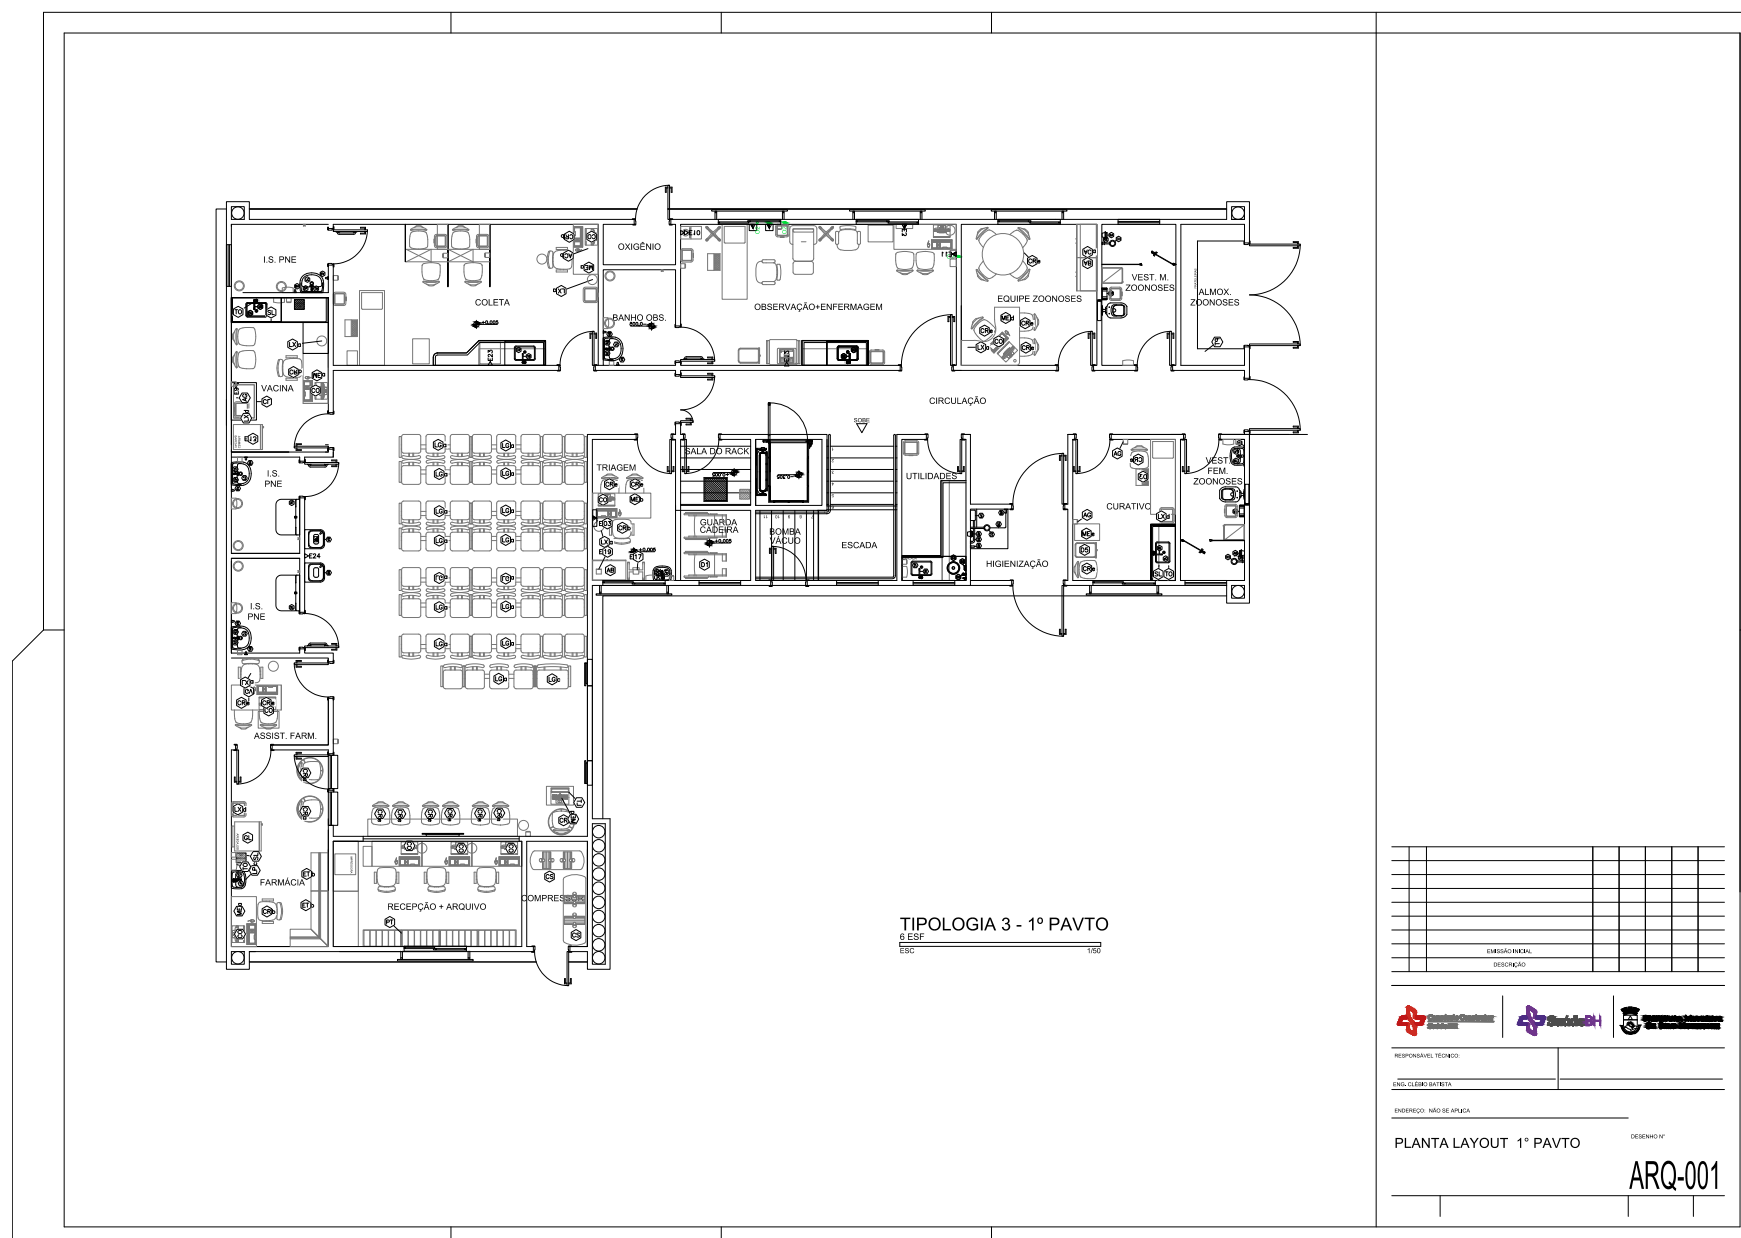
Planta tipo do primeiro pavimento de uma UBS de três pavimentos.
